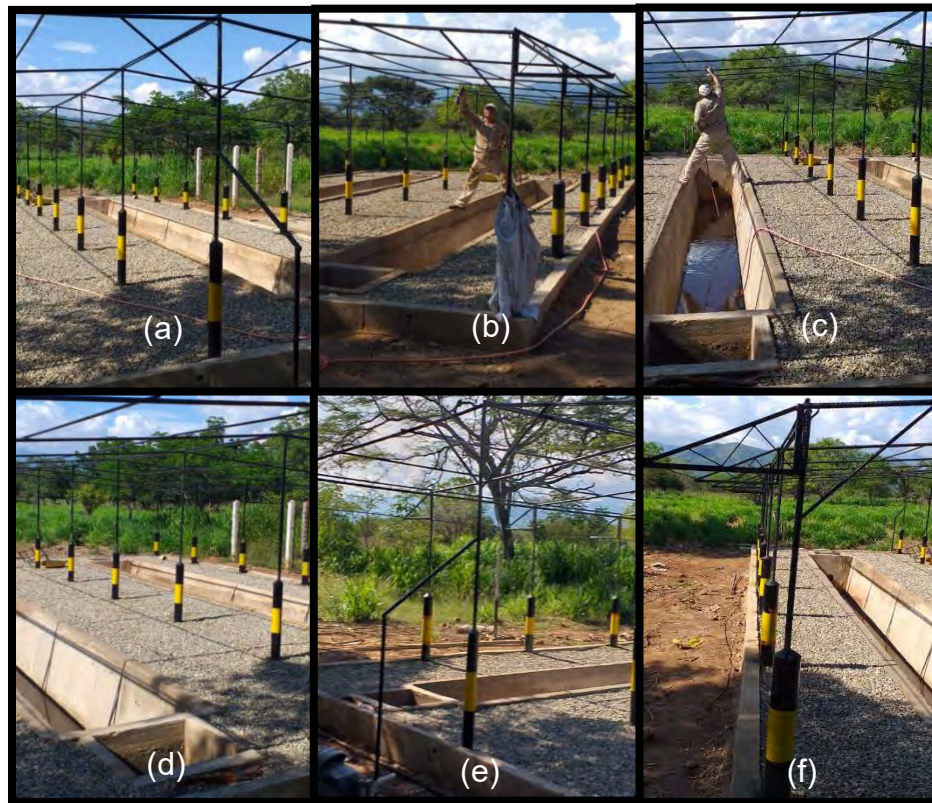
Estructura protectora del biodigestor, cubierta y pasillos laterales
